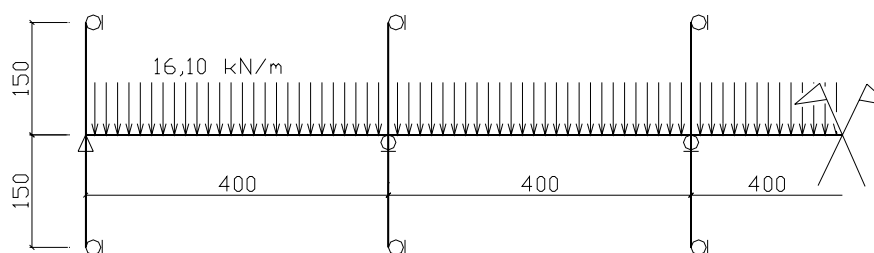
Esquema estrutural e de carregamento, Caso 4 (dimensões em cm)
